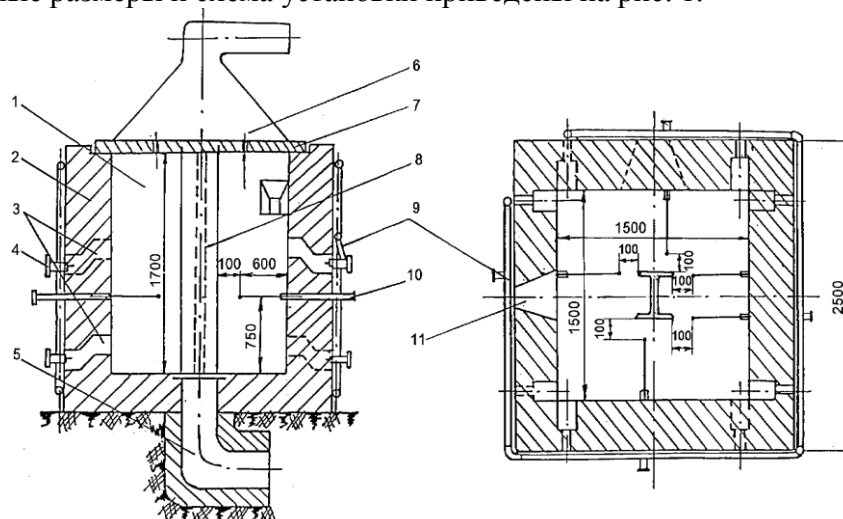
Установка для огневых испытаний малогабаритных образцов стержневых конструкций:
